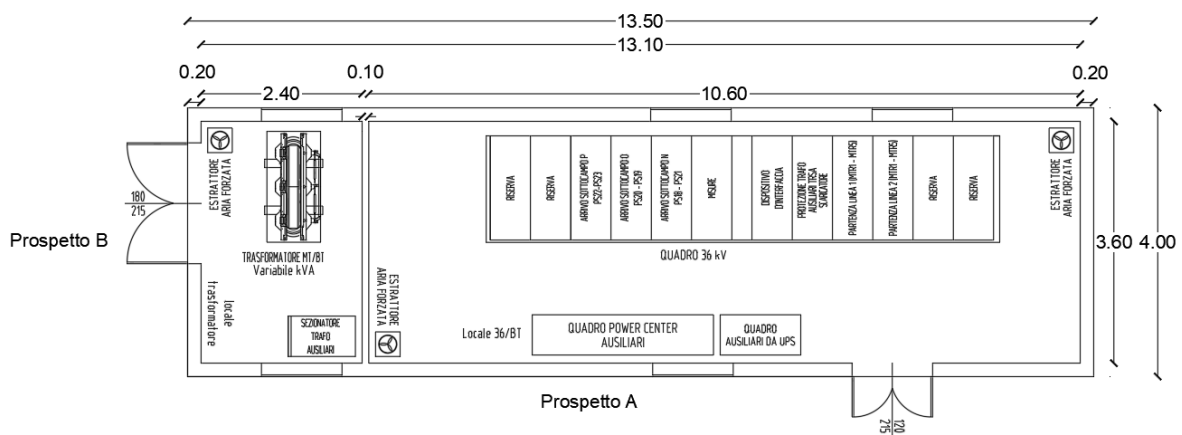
Layout MTR1, MTR2, MT3 e MTR4
